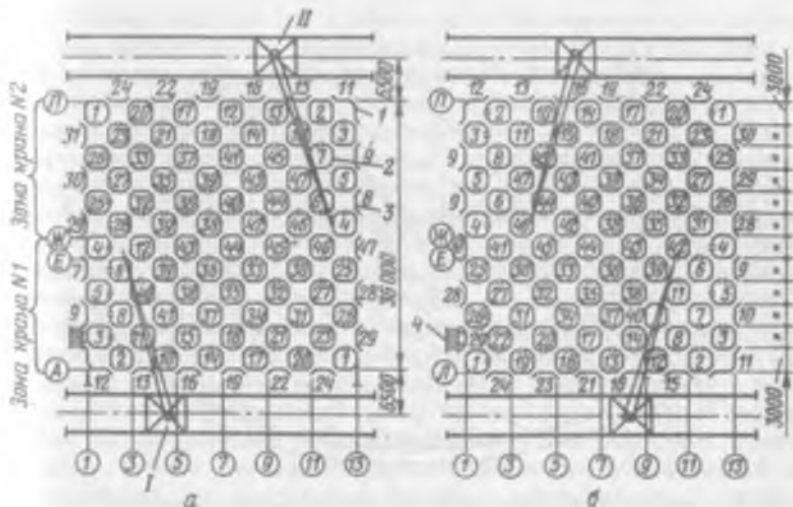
Последовательность монтажа железобетонных элементов стен силосного корпуса СКС-3-144:
